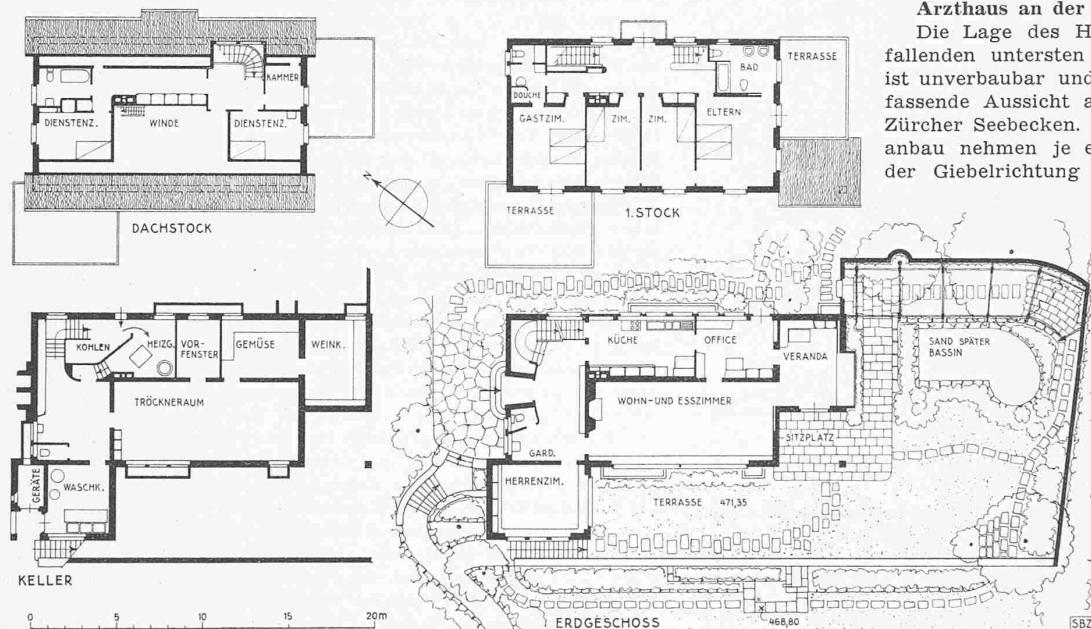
Wohnhaus an der Zollikerstrasse. Grundrisse 1:400. — Architekten DEBRUNNER & BLANKART, Zürich
